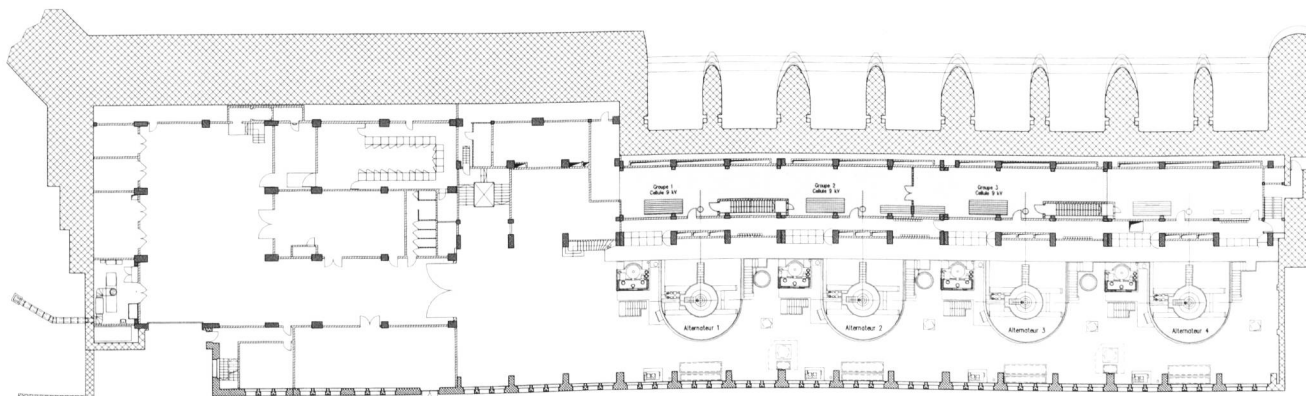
Grundriss Erdgeschoss (gerastert die beeinträchtigte und wiederhergestellte Zone).
